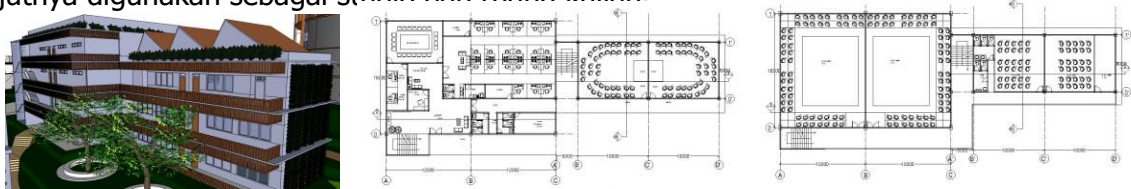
Eksterior Gedung Rektorat dan denah gedung rektorat
